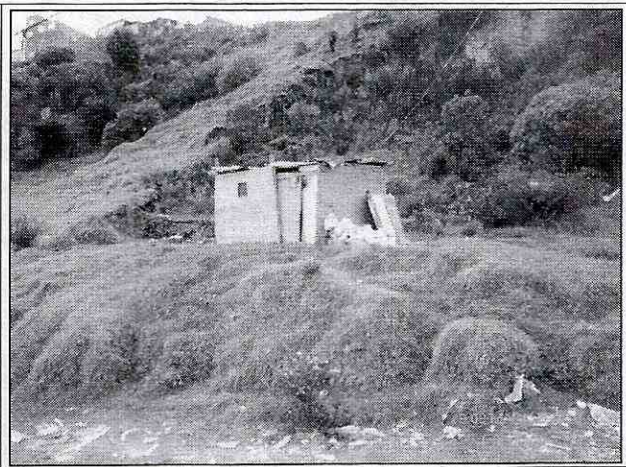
Vista de la construcción emplazada en el predio de la Diagonal 2A Sur No. 6A-44 Este, Barrio El Dorado de la Localidad de Santa Fe.
